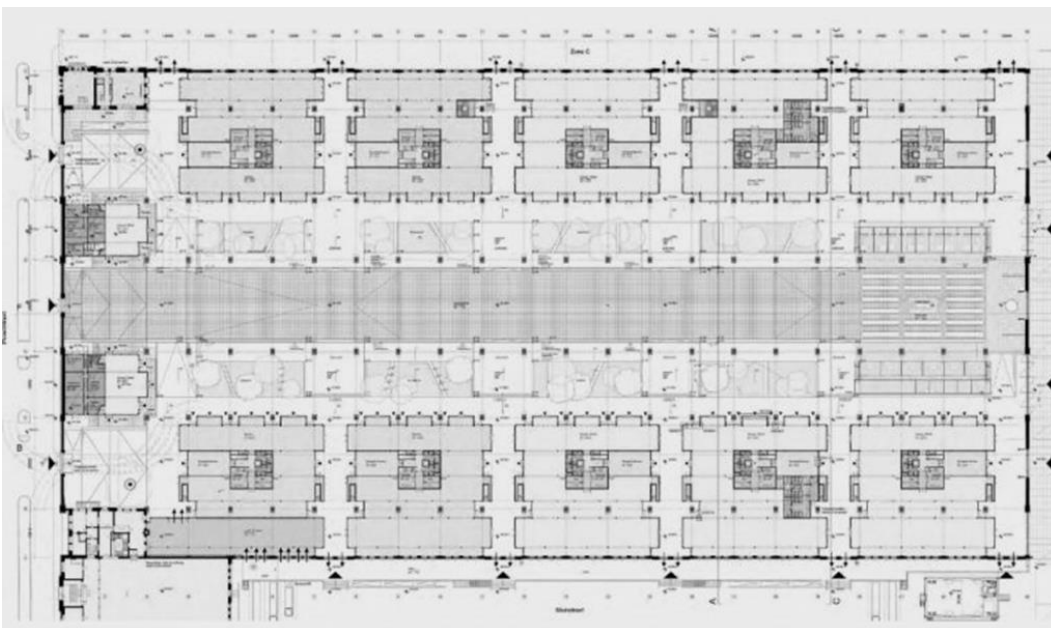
10 Blöcke und 2 Kopfbauten im Grundriss (Quelle: Extensa)
